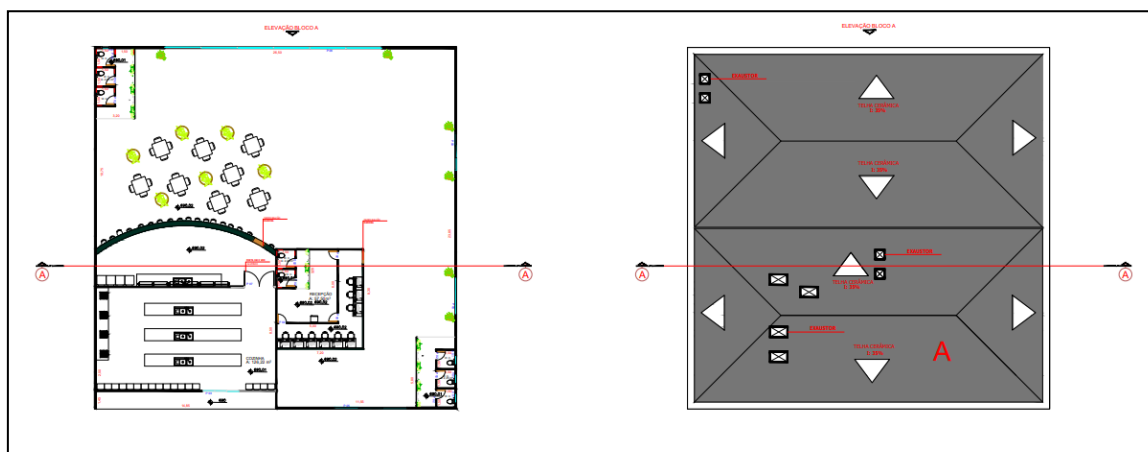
Planta baixa e planta de cobertura do restaurante e recepção
